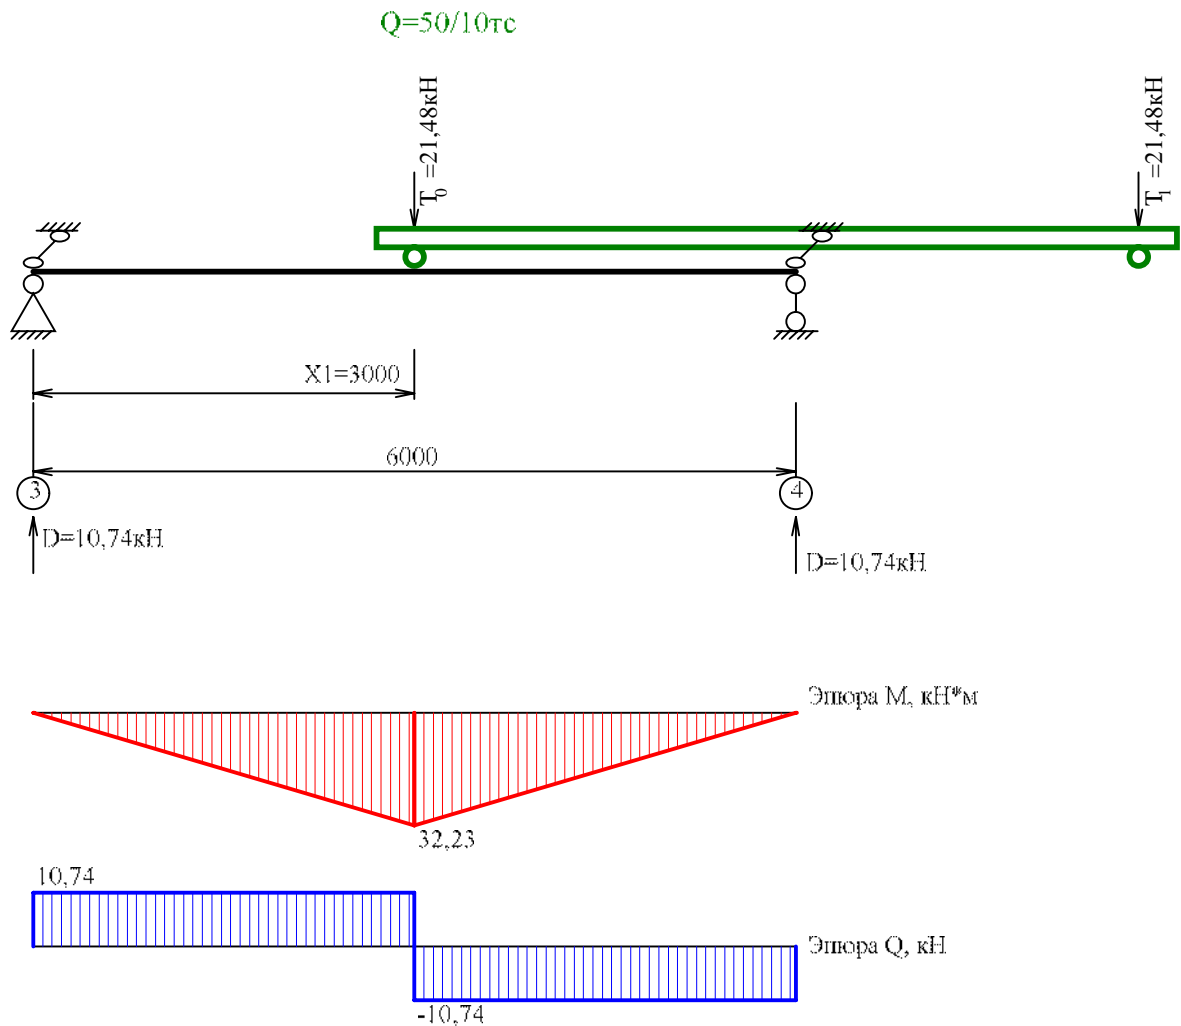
Эпюры усилий M и Q от горизонтальной нагрузки при расчётном положении крана
